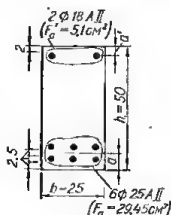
Принятая схема расположения арматуры в поперечном сечении изгибаемого железобетонного элемента.
